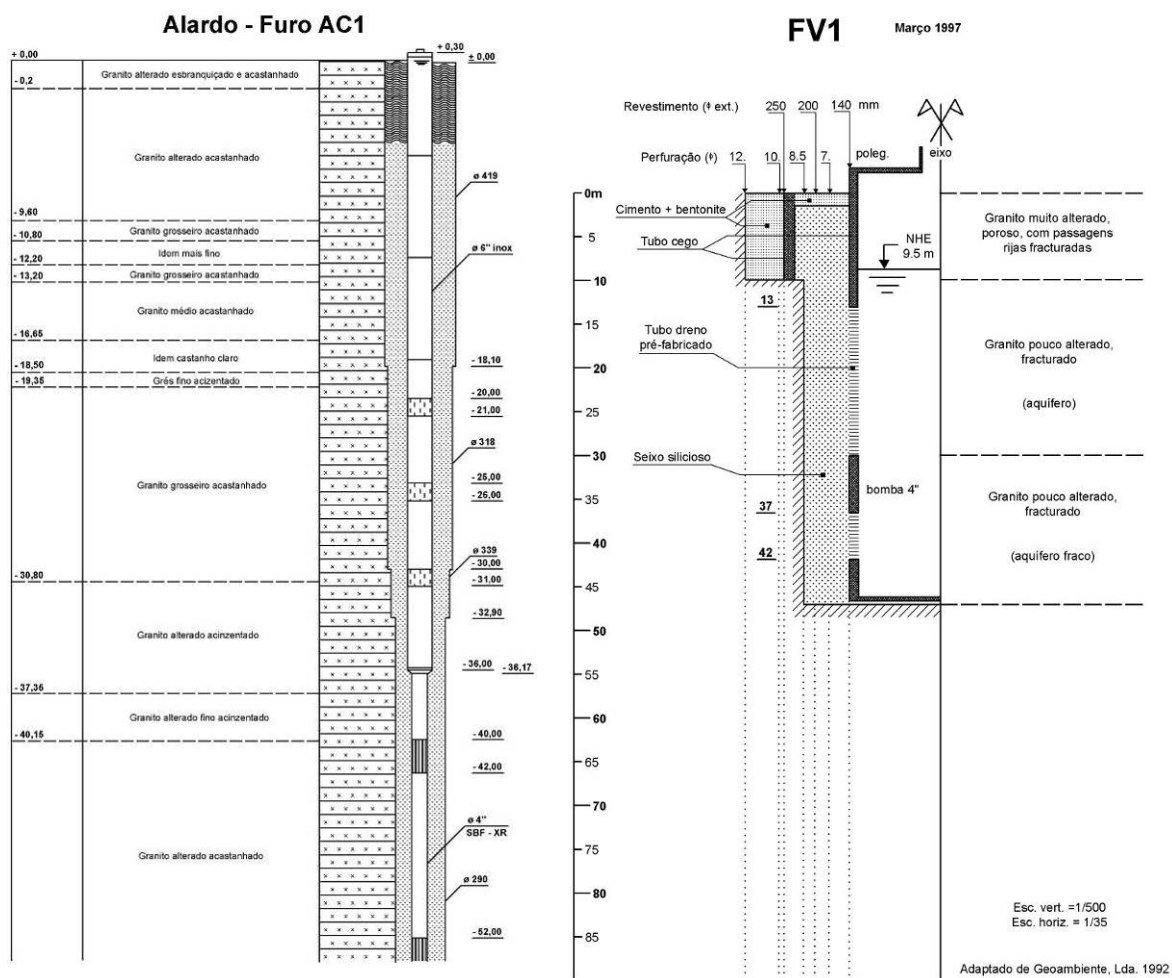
Esquema construtivo dos furos AC1 e FV1.
